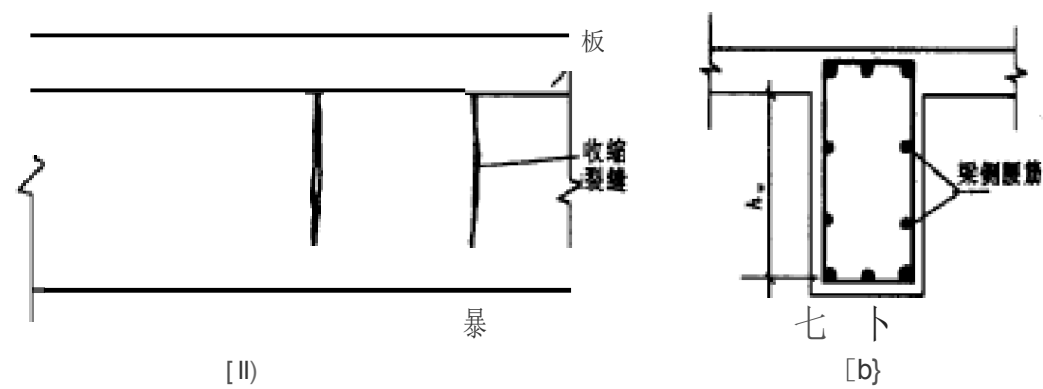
梁侧防裂的纵向构造钢筋
